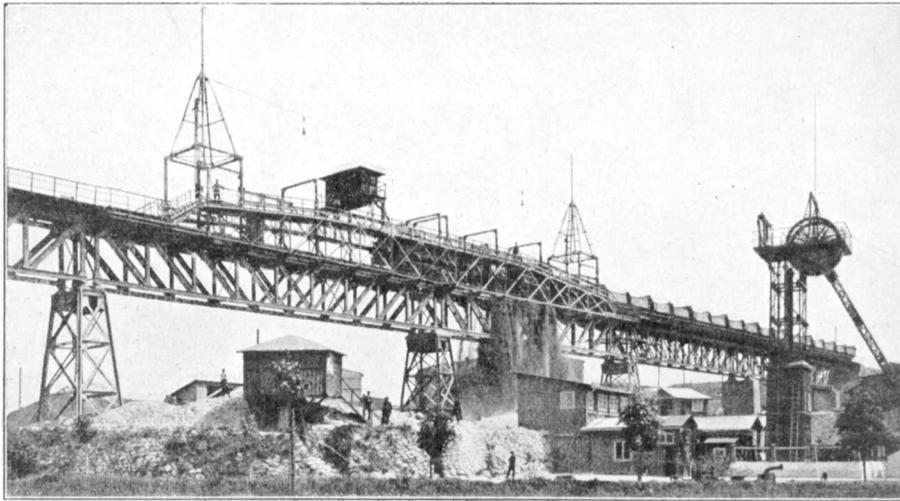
Entladebrücke am Glückaufschacht der Grube Königin Luise.
